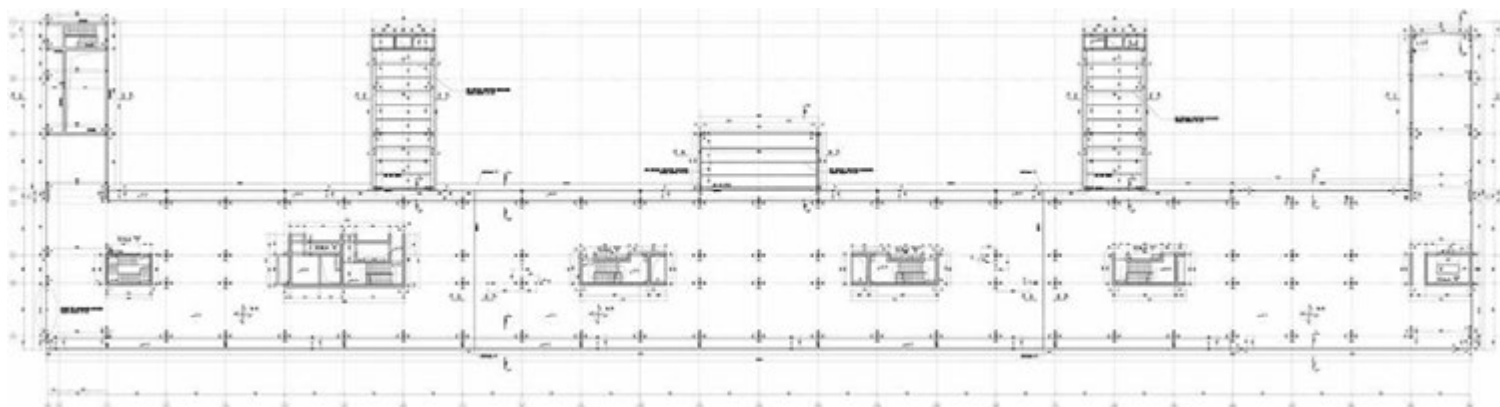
| Edificio U10 Bicocca – Pianta solaio +8.80
